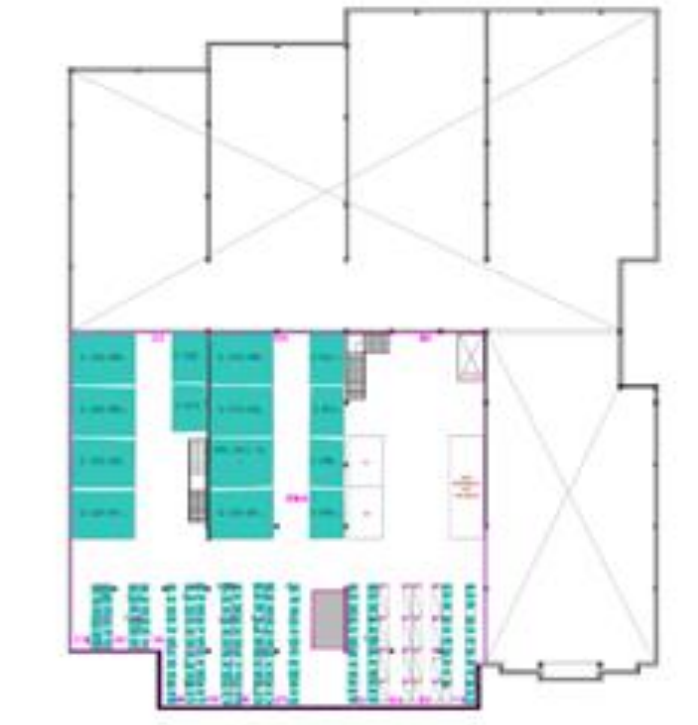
planta baixa do Armazém 2º piso Fonte: Covet Group
